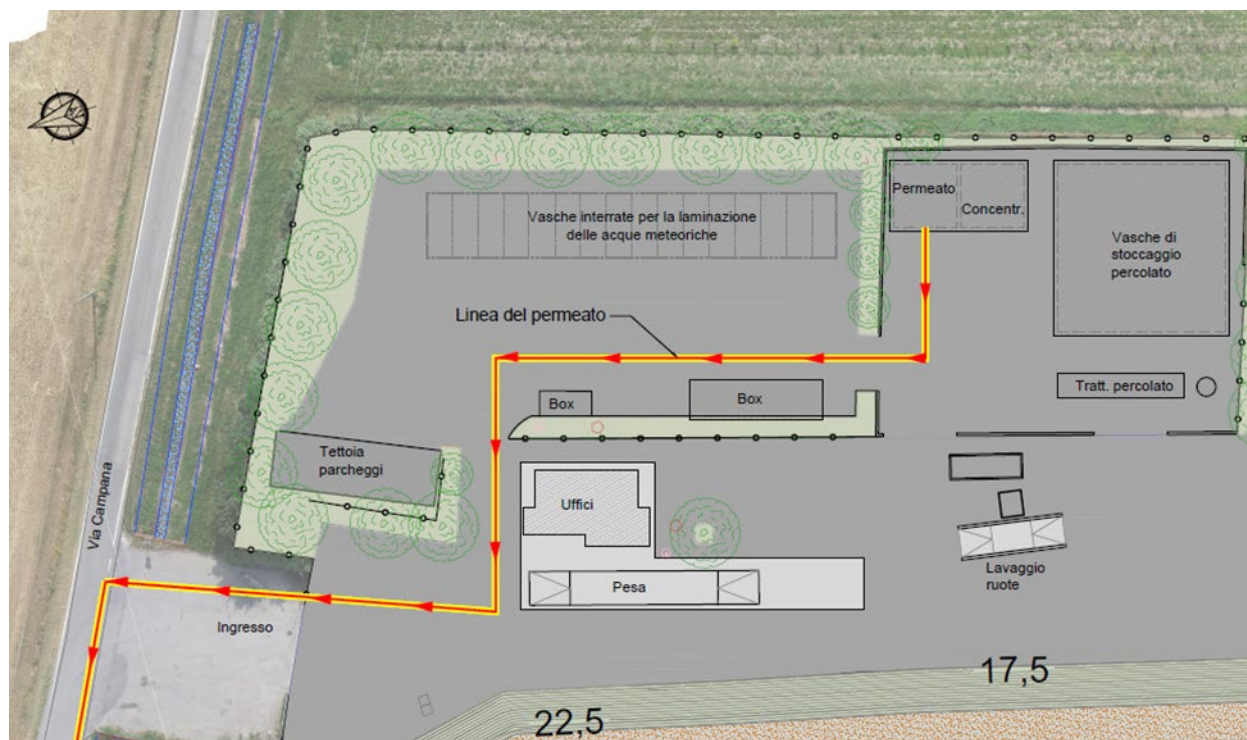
Rete fognaria in progetto – Tavola 4.5 del progetto
